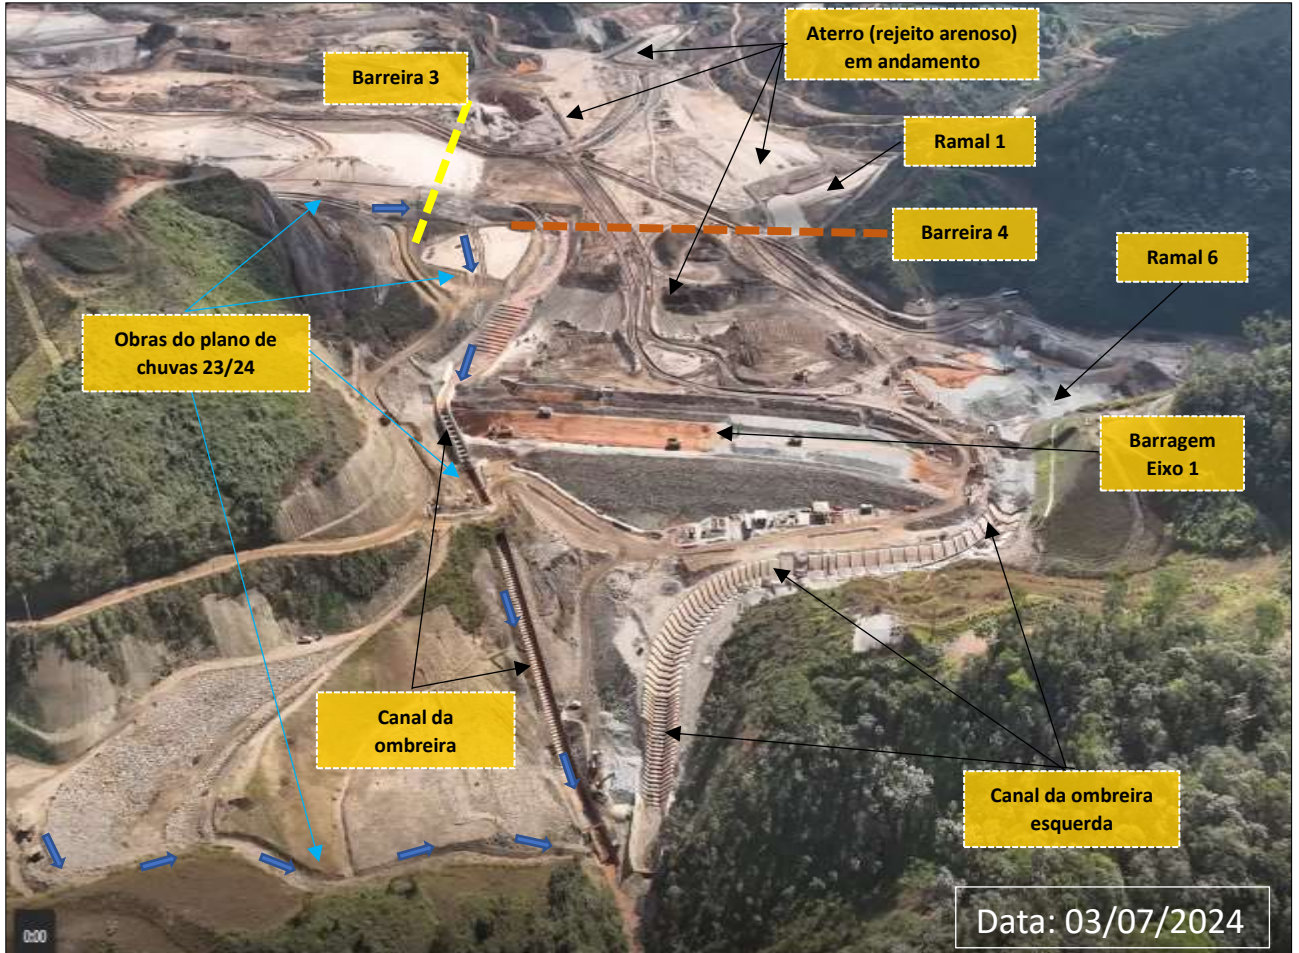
Visão Geral da Barragem Eixo 1 (Obras em Andamento)
